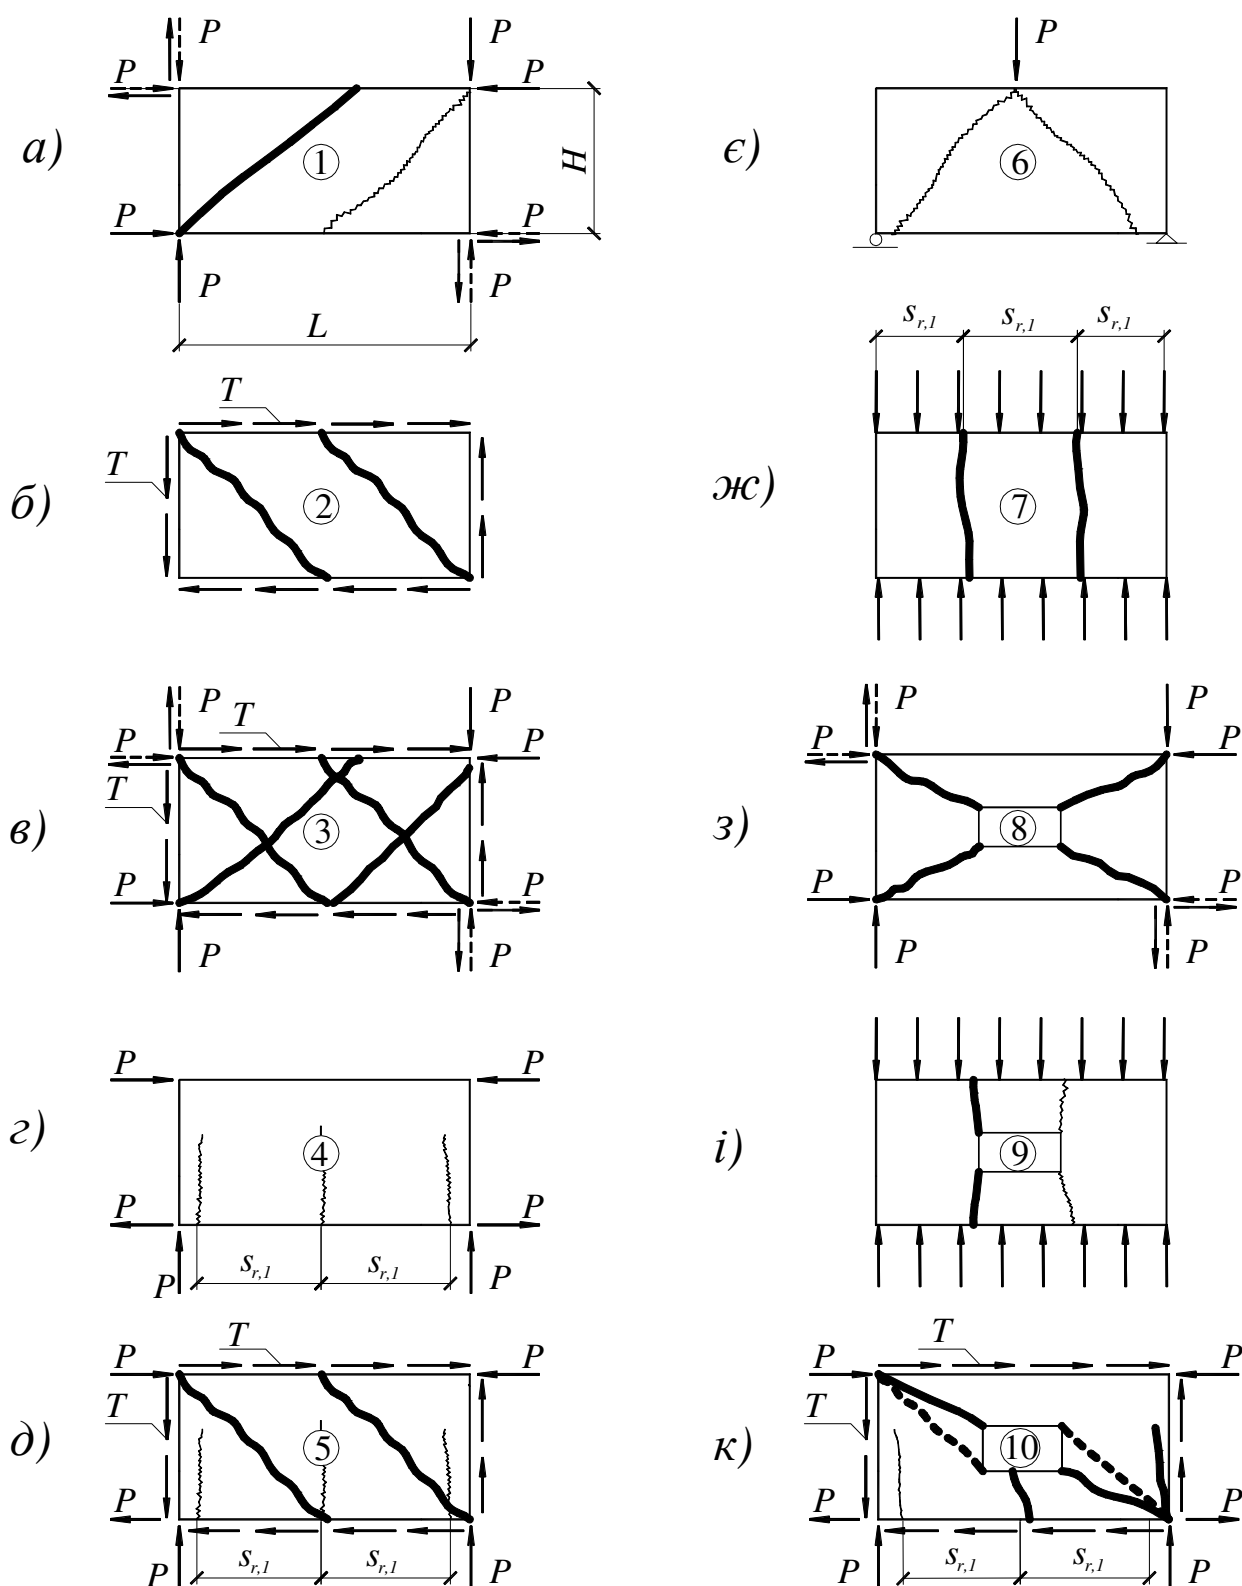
Аналіз напружено-деформованого плосконапружених залізобетонних конструкцій за результатами досліджень (із накладенням різних силових впливів): а – перекіс; б – зсув; в – перекіс зі зсувом; г – згин; д – зсув зі згином; е – згин; ж – стиск; з – перекіс (із вікном); і – стиск (із вікном); к – зсув зі згигом (з вікном)
